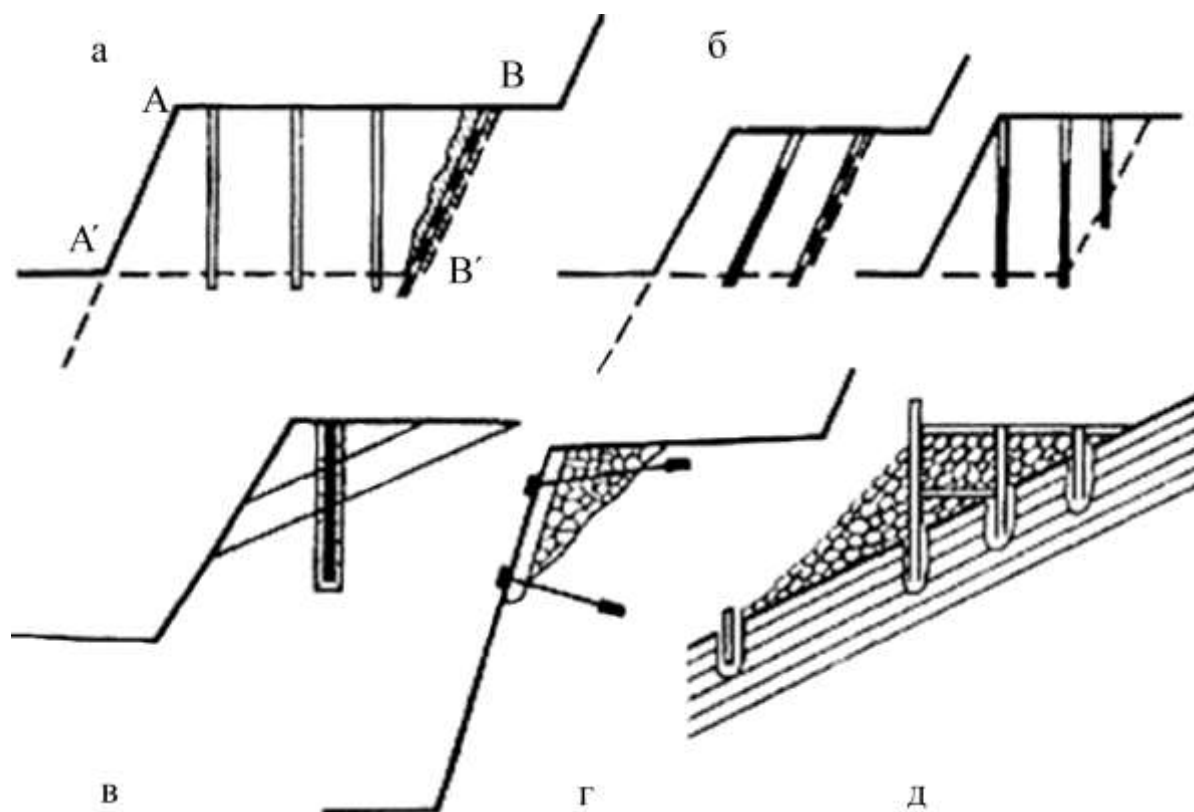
Схемы закрепления осыпей: а – предварительное щелеобразование; б – заоткоска уступа наклонными и вертикальными скважинами; в – укрепление железобетонными сваями; г – искусственная бровка; д – укрепленная берма
